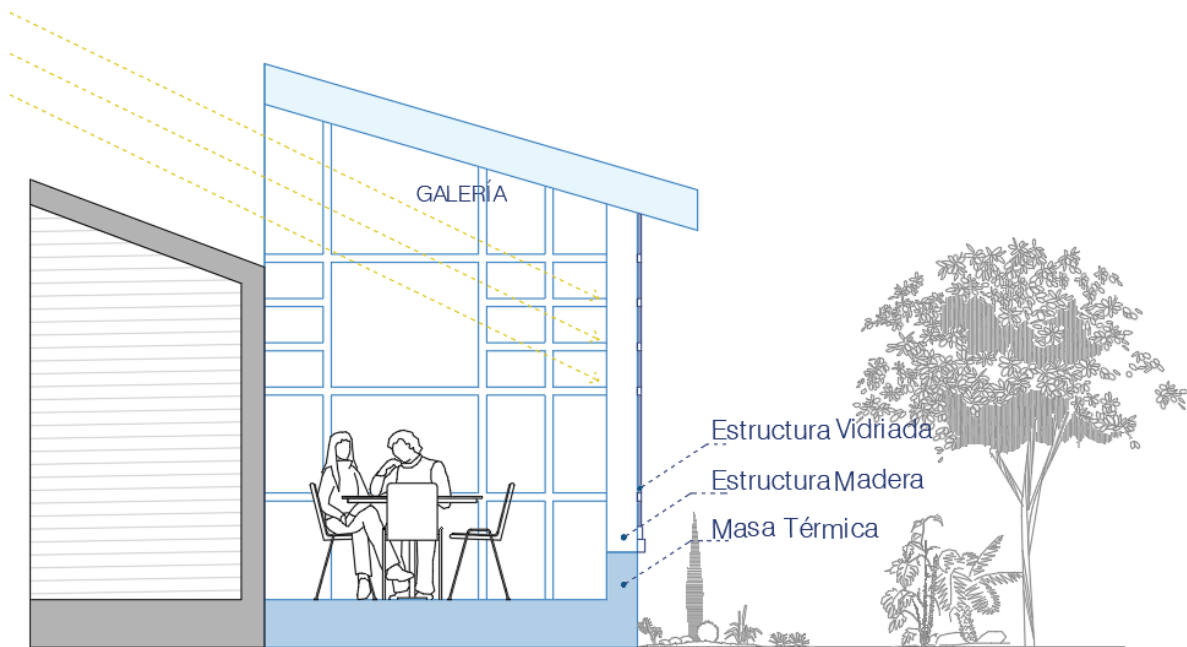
Corte esquemático Galería solar casa Kapstein. Fuente: Elaboración Propia
